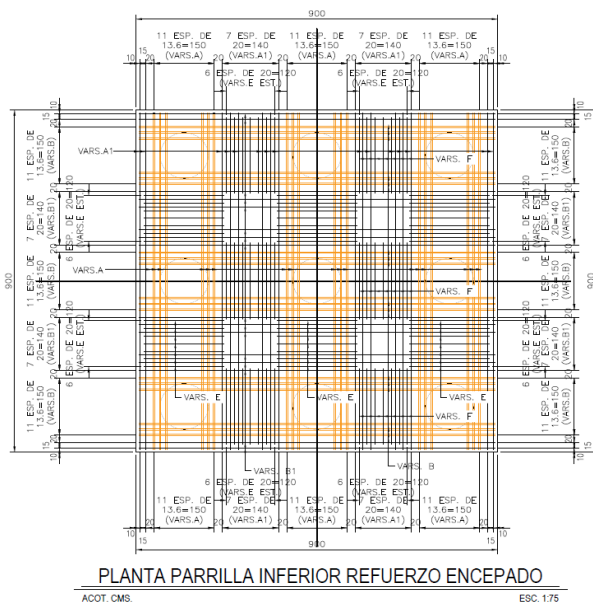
y 100 ARI Ingeniería (2023) "Características de armado de refuerzo para zapatas de apoyos intermedios"
